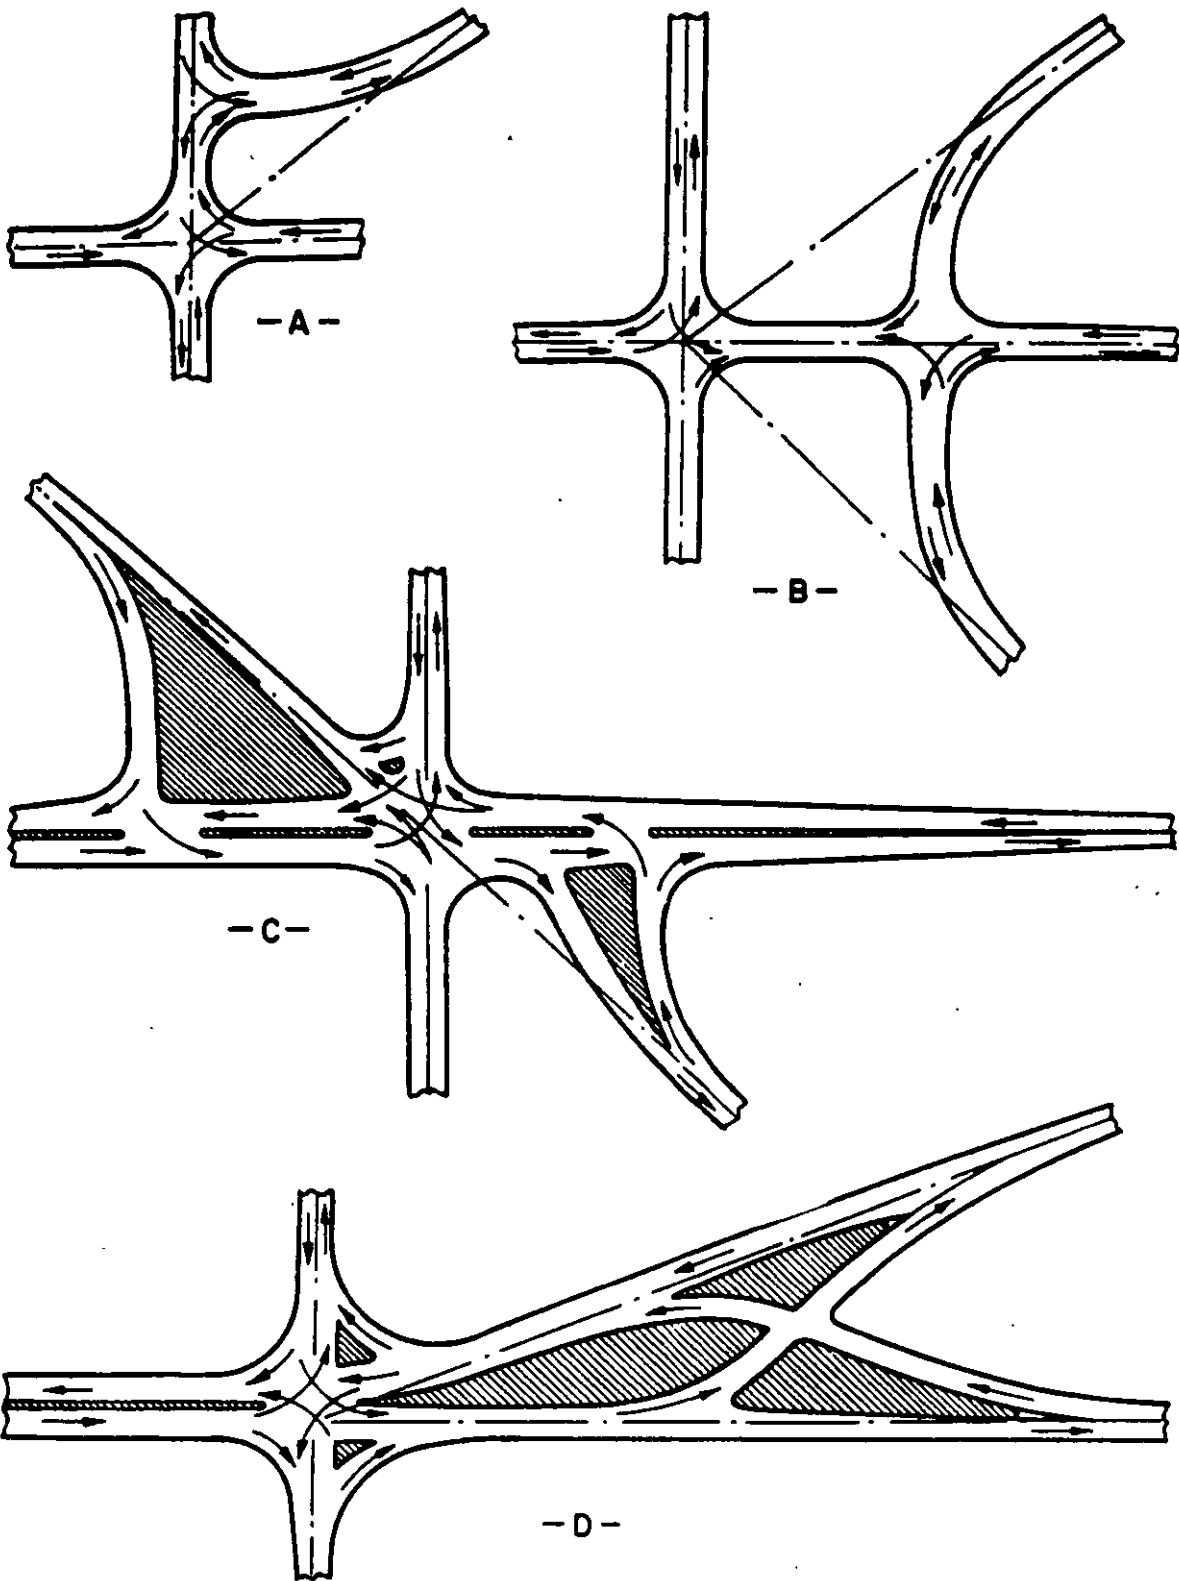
ENTRONQUES DE RAMAS MULTIPLES
